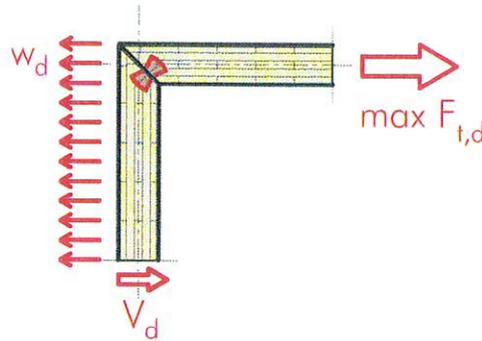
X-Fix-L-Verbinder in einem auf Zug beanspruchten (Wand-) Eckstoß – Variante II: auf Gehrung gestoßen (Maße in mm)
